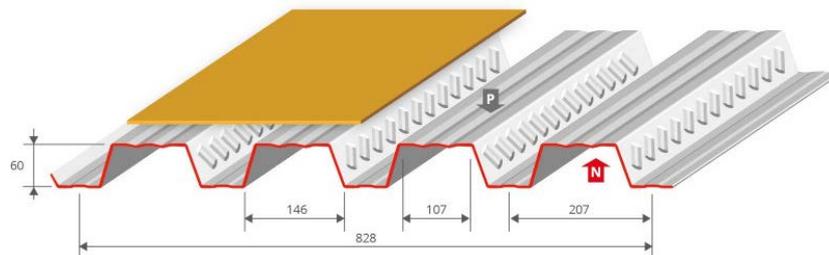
Dimensions d'un plancher sec (WOODEO 60)
